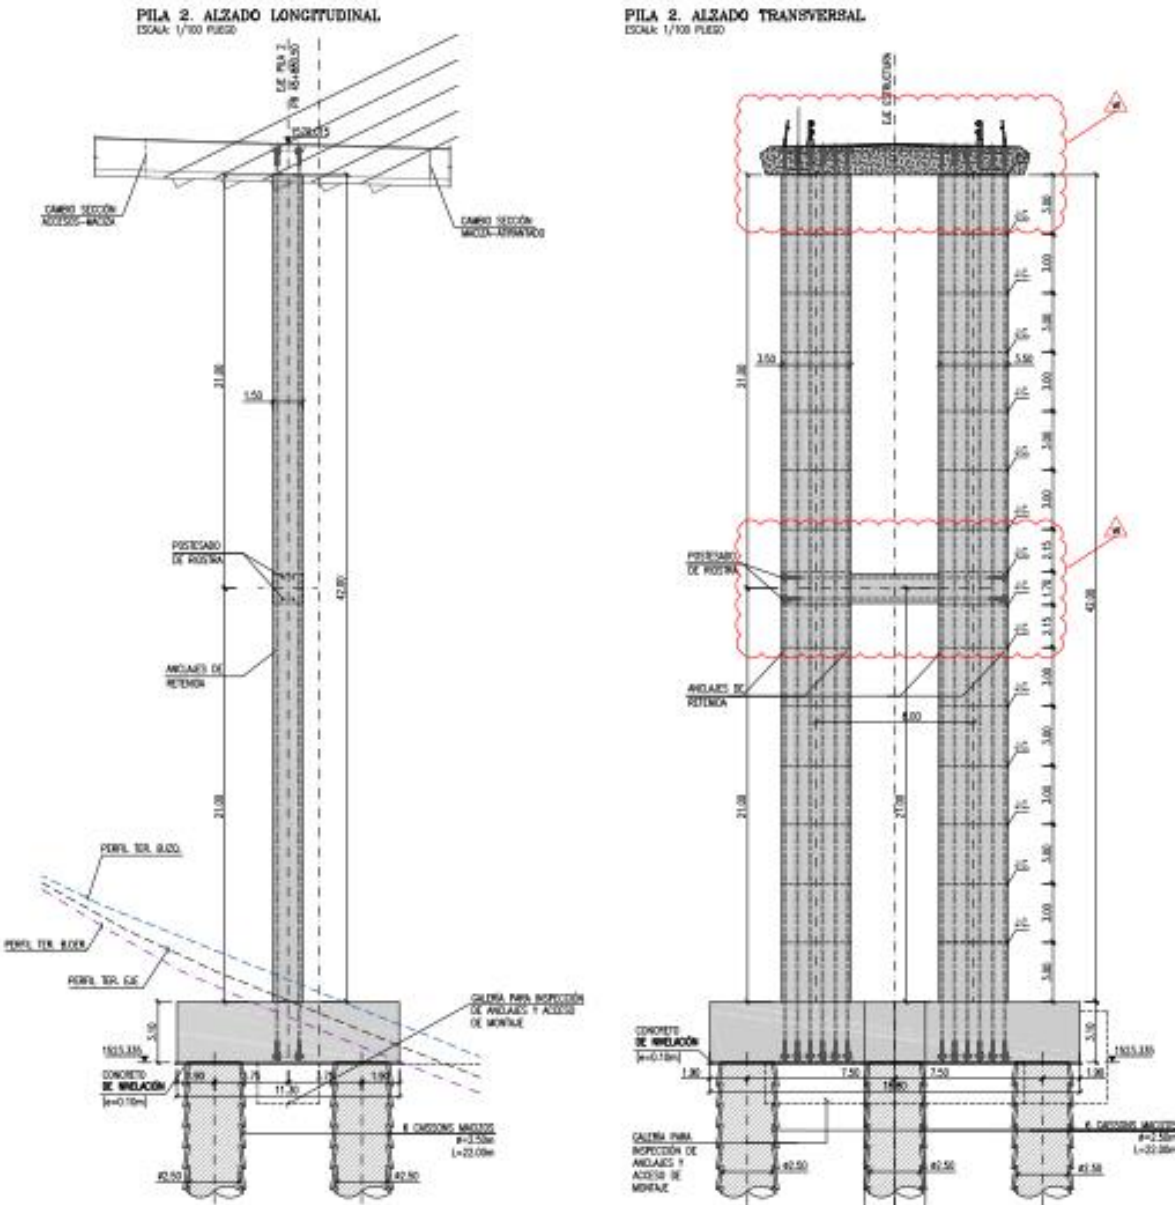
Pila 2 Puente Atirantado Hisgaura
